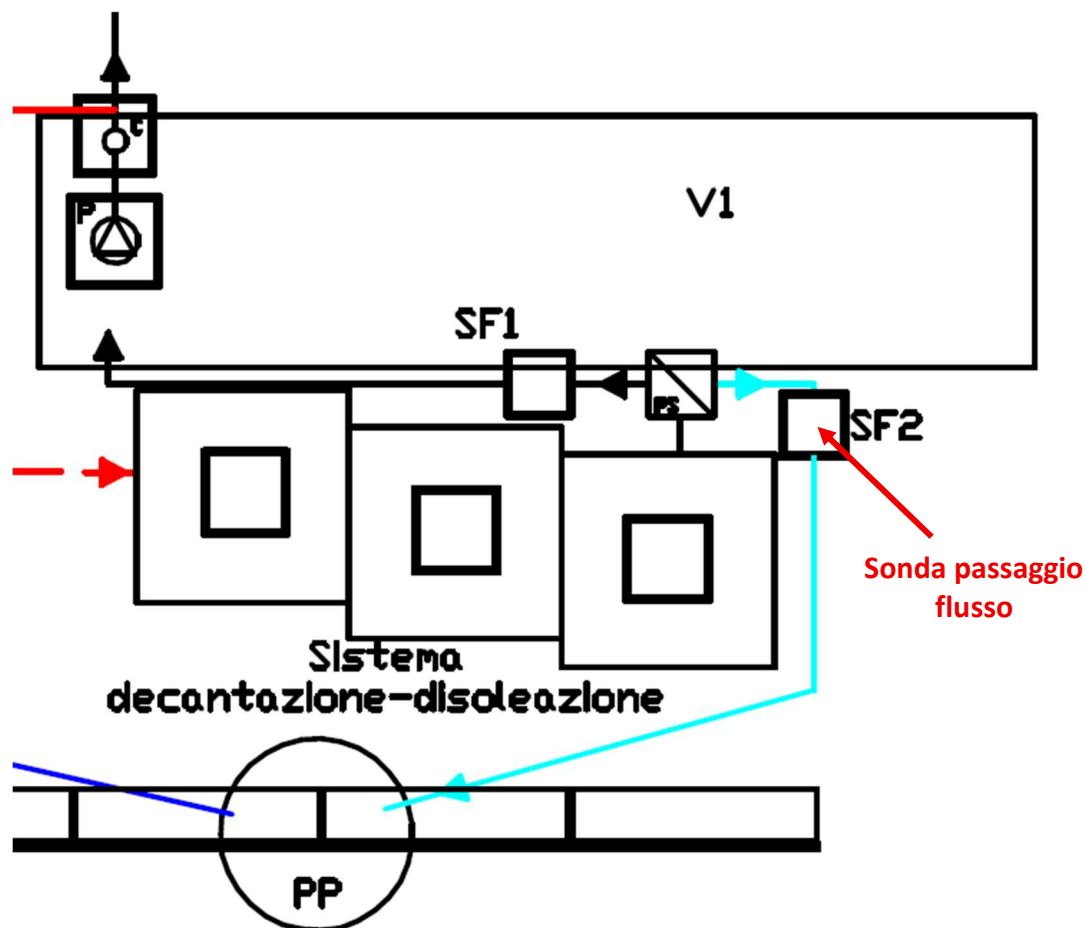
Particolare della planimetria scarichi: pozzetto di ispezione seconda pioggia SF2 ove è installata la sonda
